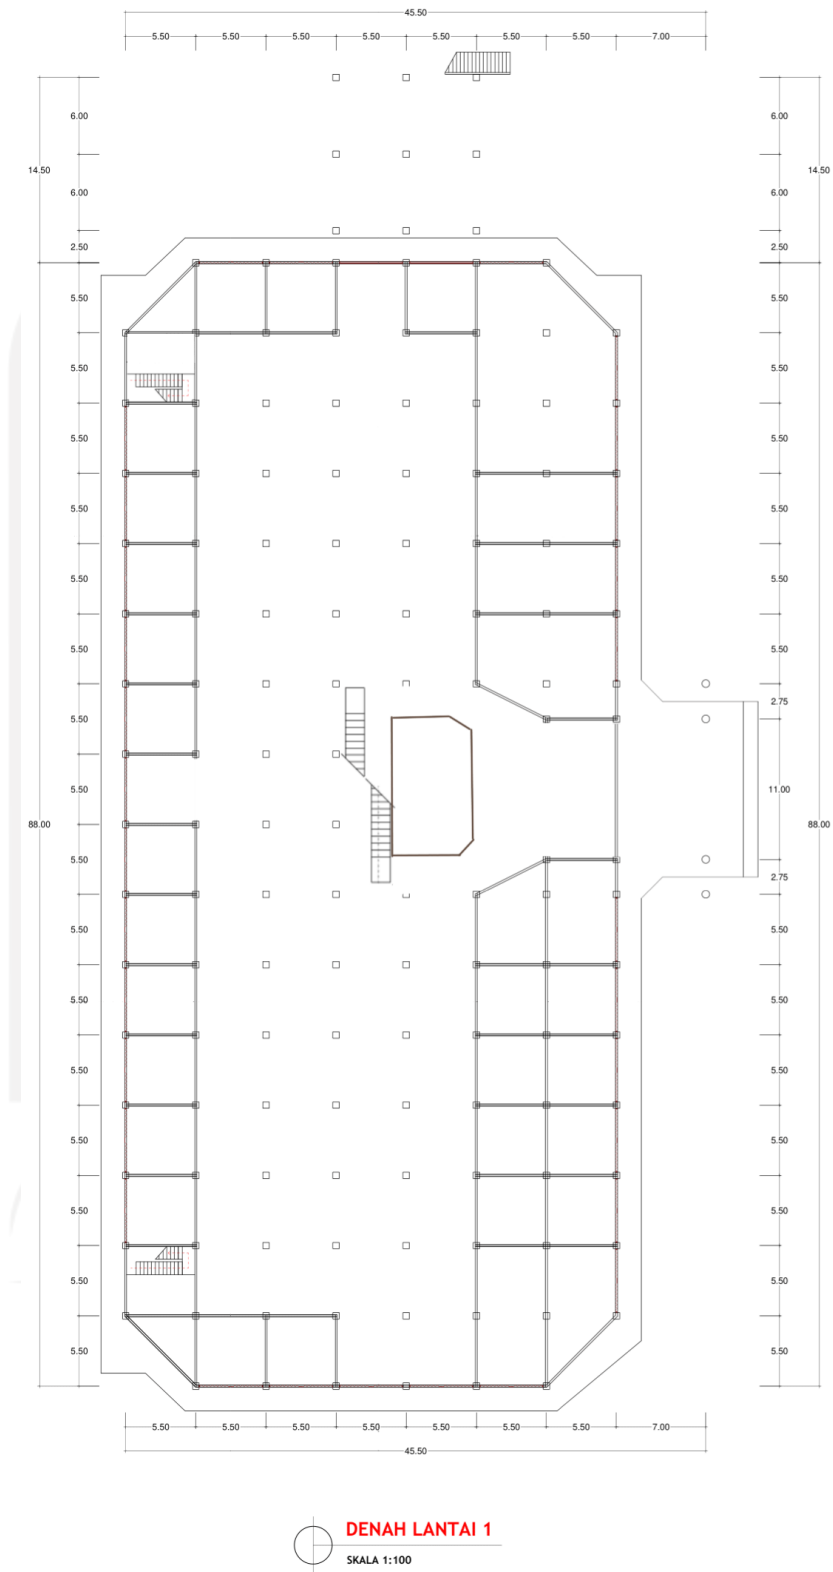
5 Siteplan Bangunan Plasa Klaten
